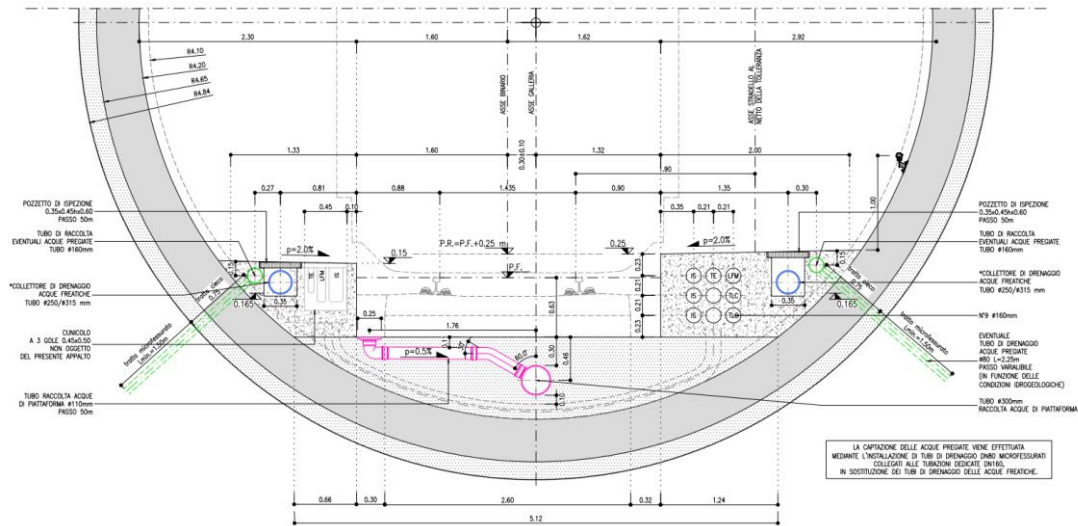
Sezione pozzetti acque di drenaggio - Scavo meccanizzato
